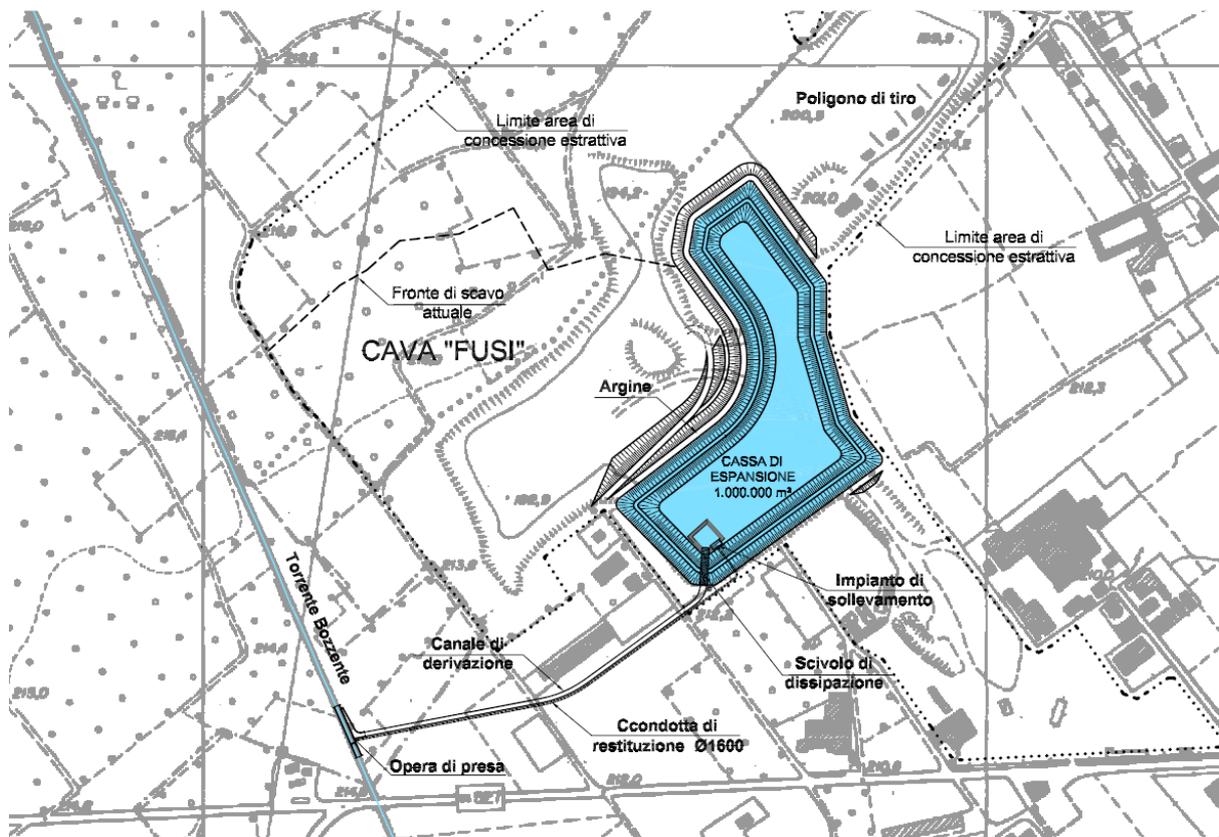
planimetria progetto CAVA FUSI GERENZANO
